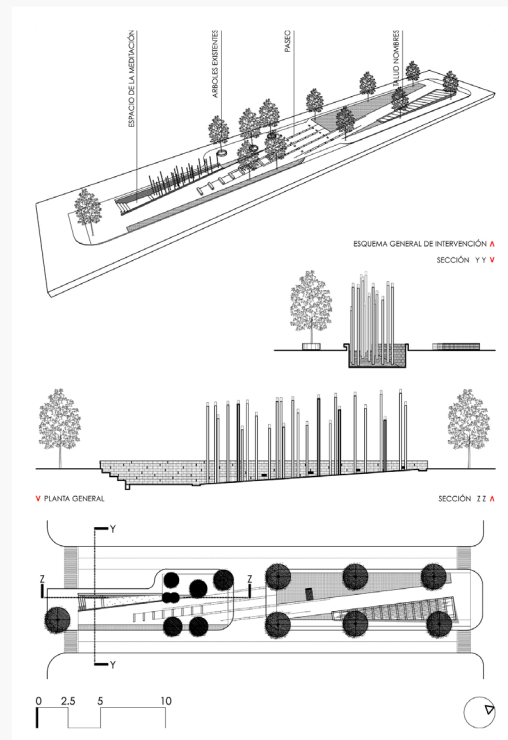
Planimetría general. Planta, Secciones y Axonométrica. Fuente: elaboración propia.
